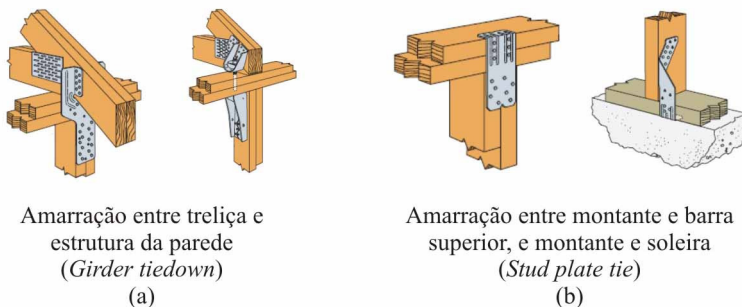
Tipos especiais de amarração para furacões e abalos sísmicos (adaptado de STRONGTIE, 2008).
